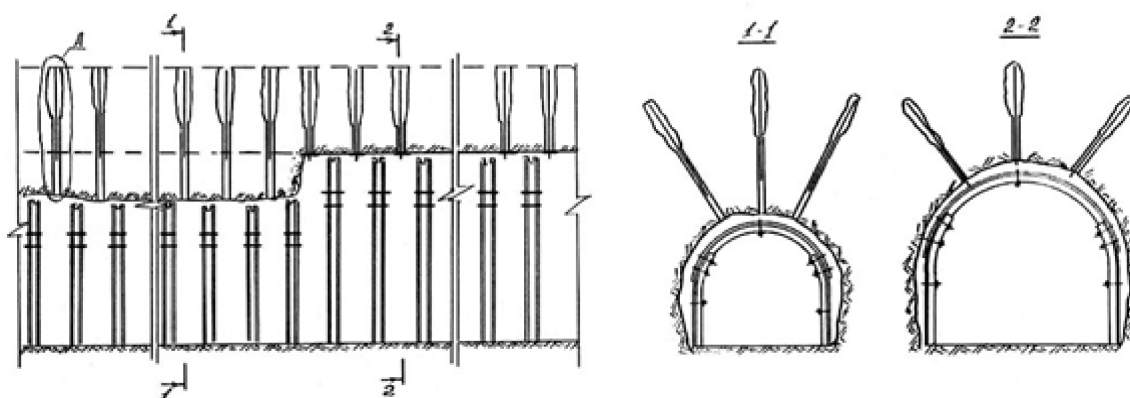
Технология ремонта выработки с использованием анкерной крепи
